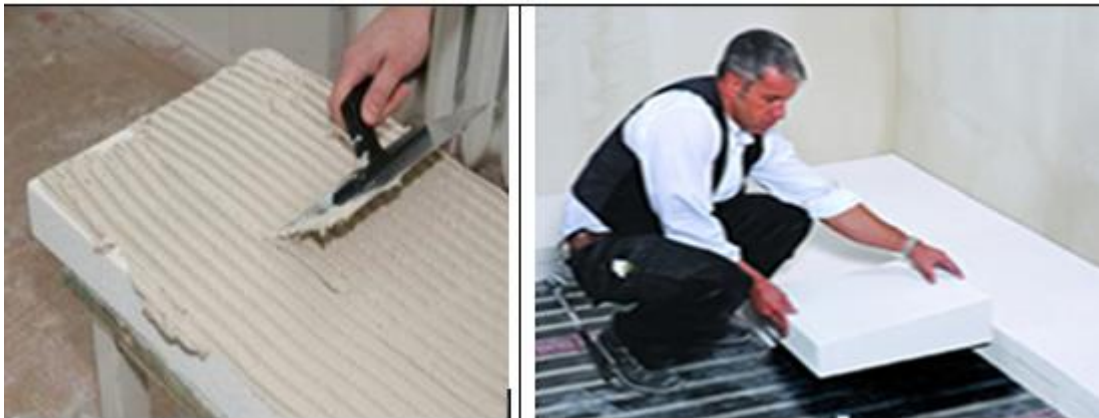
приведена схема утеплення підлоги або плит перекриття.
